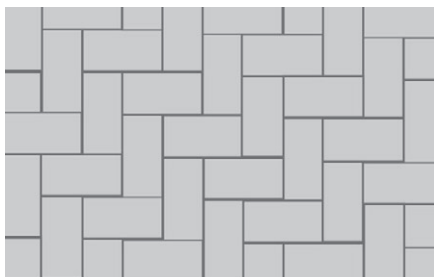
Укладка плитки «елочкой» с обрамлением из прямоугольных и квадратных плиток по краю
